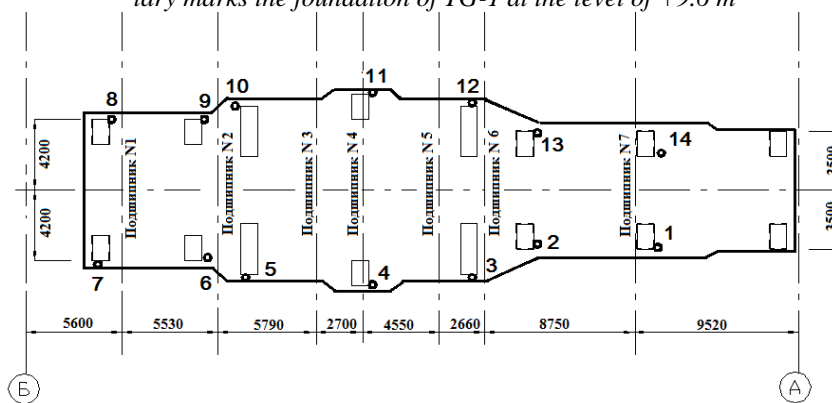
Схема расположения осадочных марок фундамента ТГ-1 на отметке +0,6 м / Location scheme sedimentary marks the foundation of TG-1 at the level of +0.6 m
